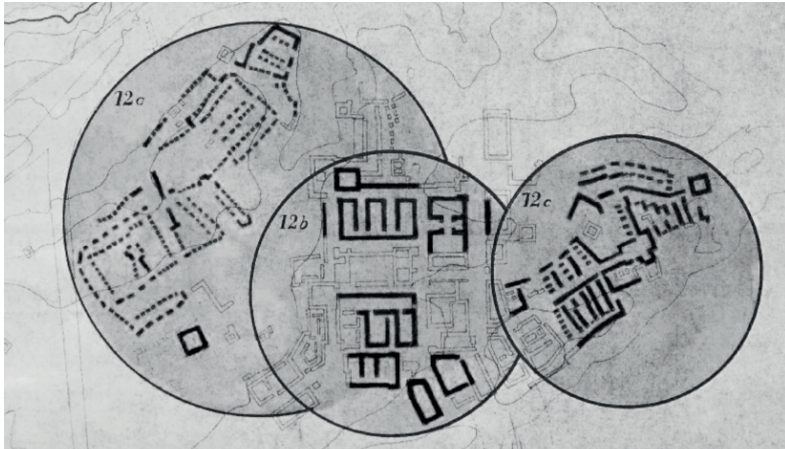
WAG, Plan der Siedlung Spallerhof im Bereich 12 c, 1943
